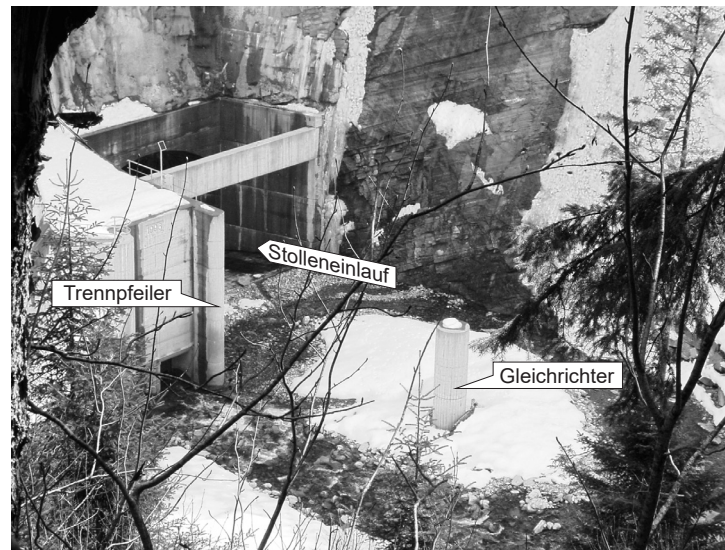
Redresseur devant le tunnel de contournement sur la rivière Rovana, Suisse (Lange & Bezzola 2006).
